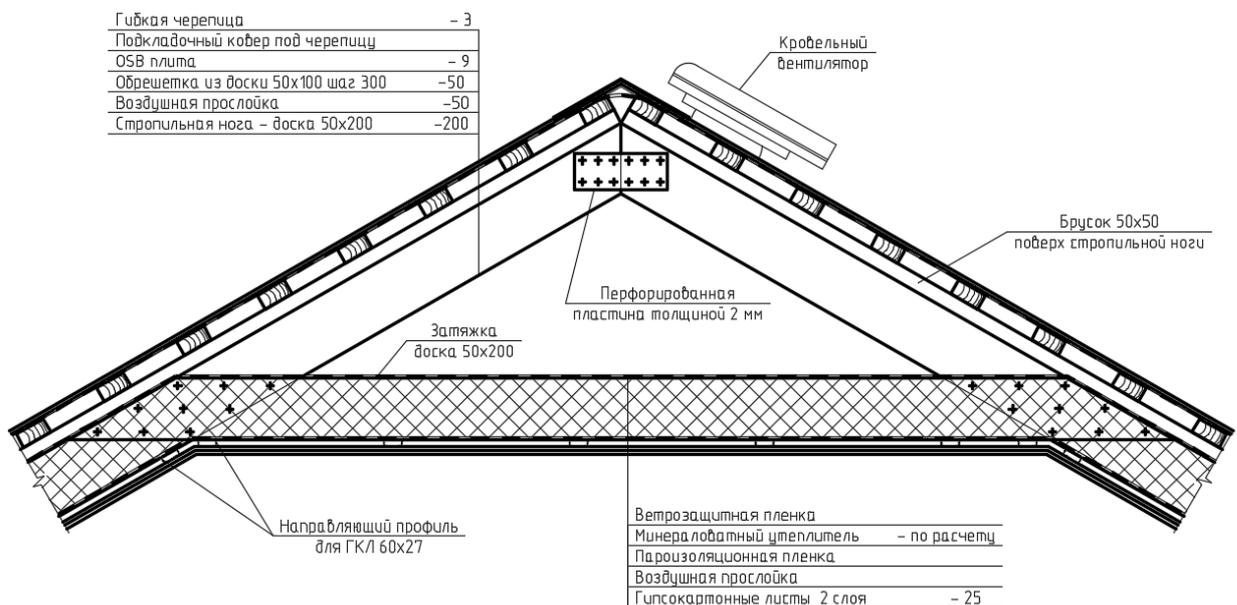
К сбору нагрузок от крыши и чердачного перекрытия
